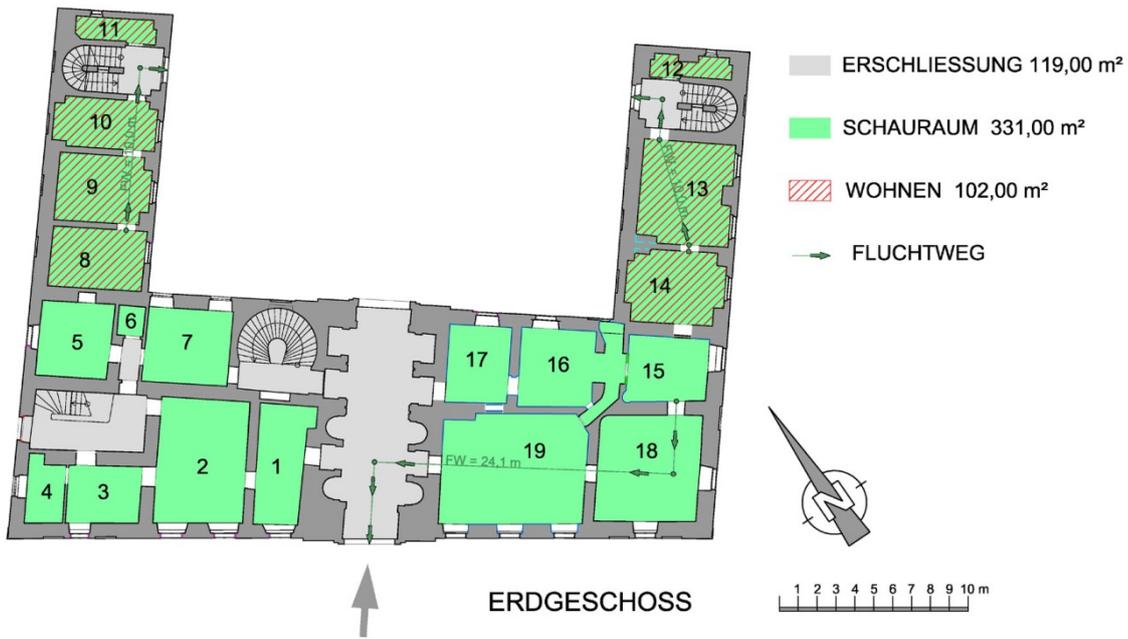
zeigt den Grundriss des Schlosses Süssenbrunn
